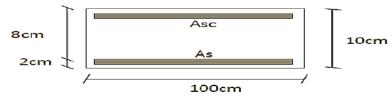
Dimensions de la section dangereuse de l'acrotère.
